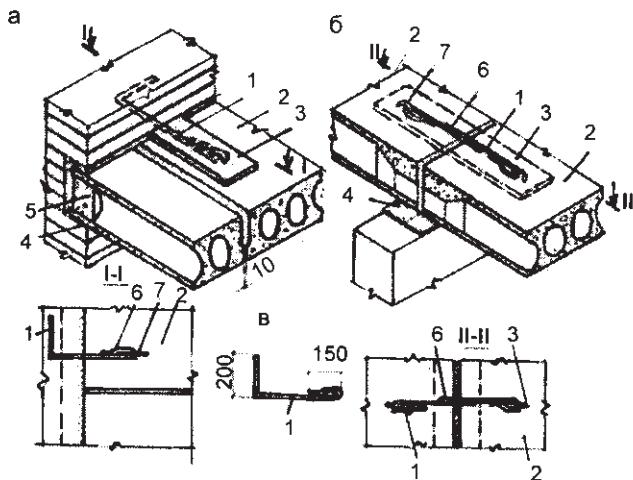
Узлы опирания многопустотных железобетонных панелей перекрытия
